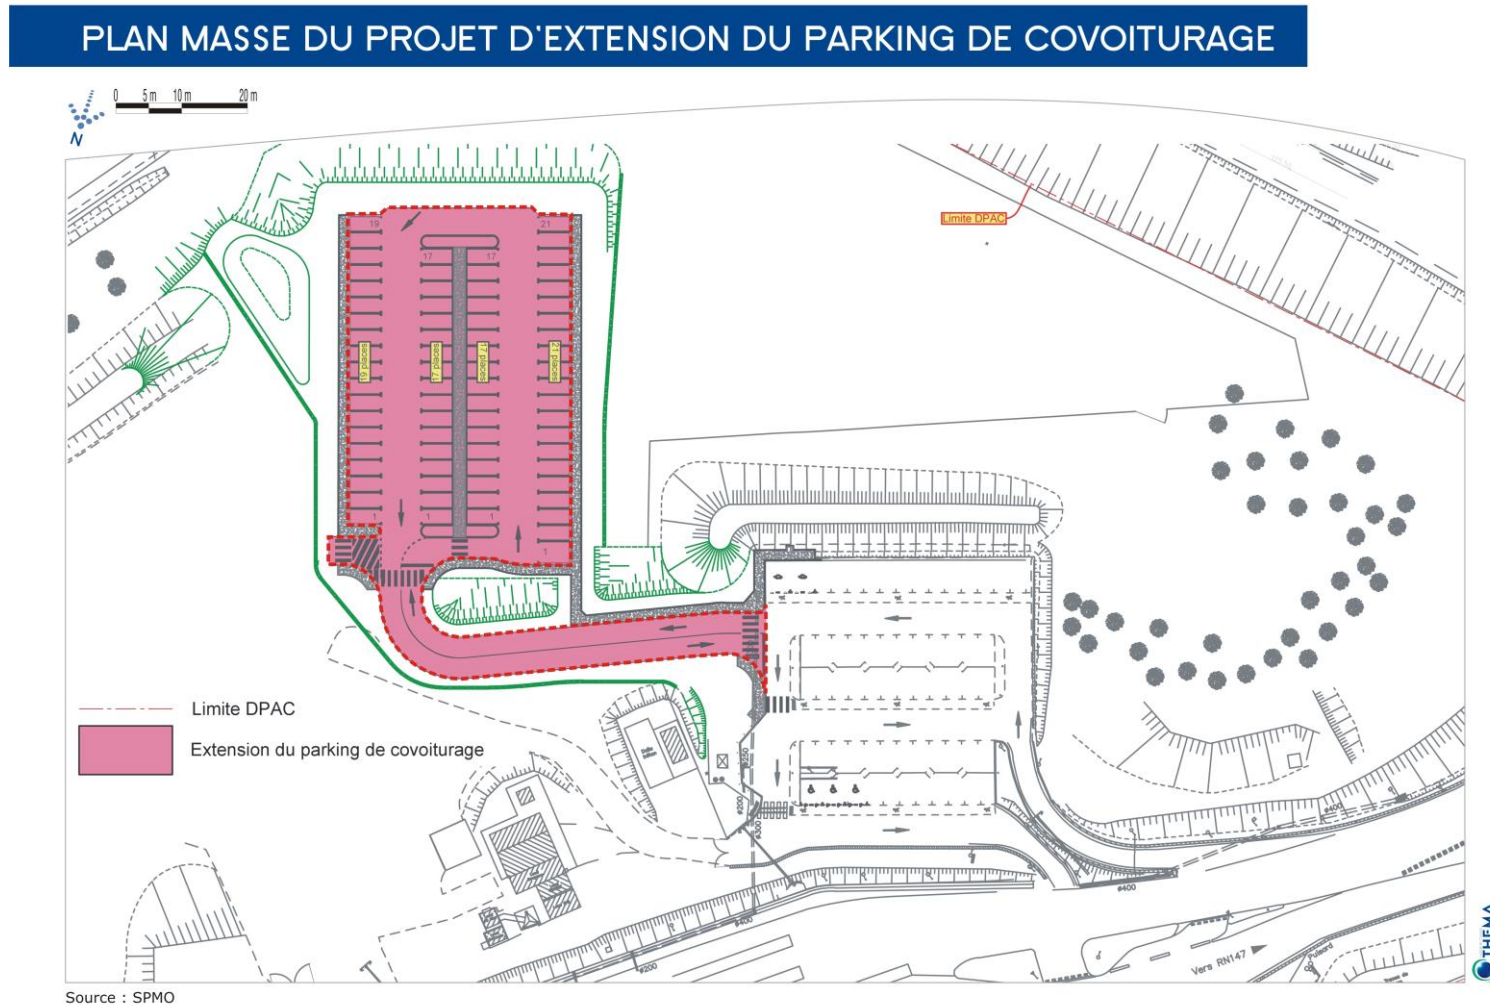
Plan masse du projet d'extension du parking de covoiturage
